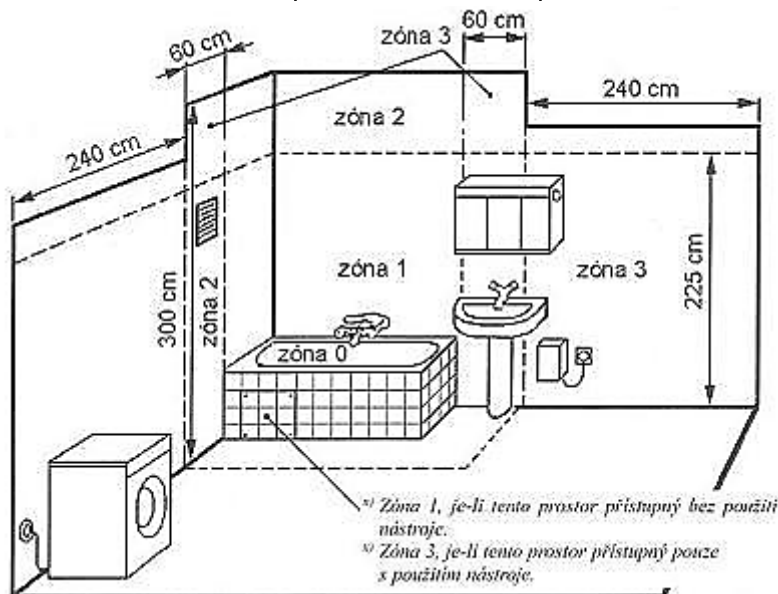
Zóny pro ukládání vedení v pokojích [25]
